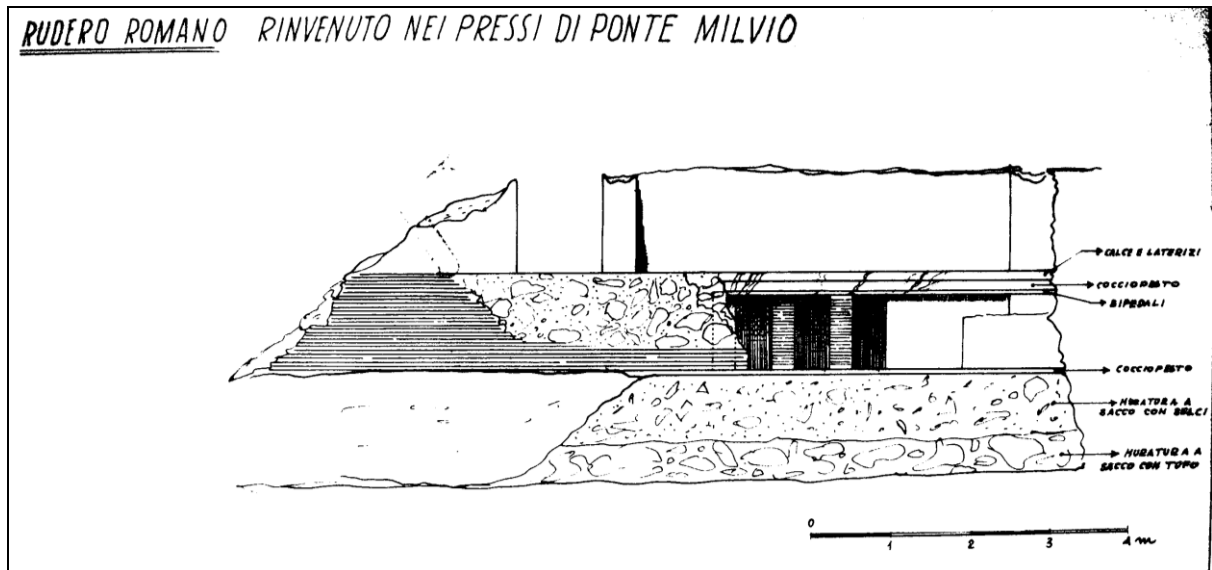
Sezione prospettica dei resti dell'edificio UT 67 (ASSBAR, Collezione disegni).
